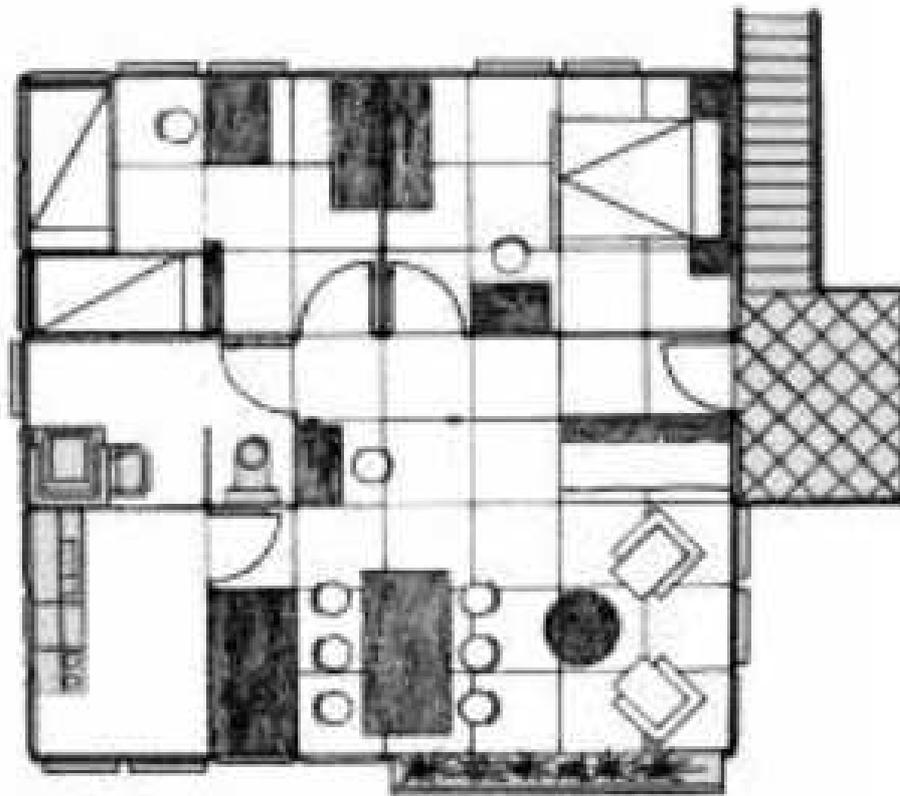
Planta baixa da casa Standart, projetada por Jean Prouvé, em Meudon, Paris. Fonte Nils (2007) apud Davico (2013).
